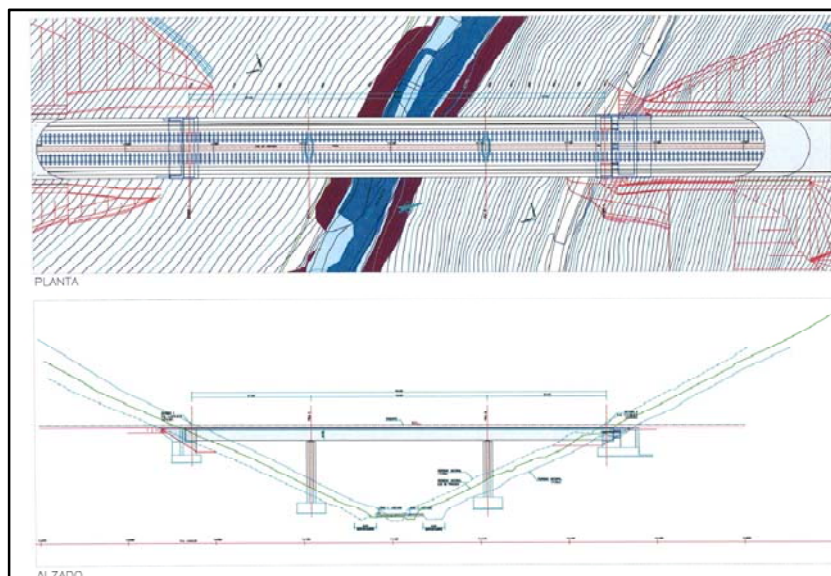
a-Perfiles en planta y en alzado del viaducto (ver Anexo I)
